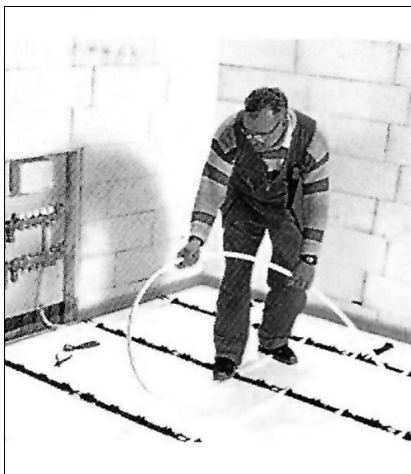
Укладка и крепление трубы к стальной арматуре
